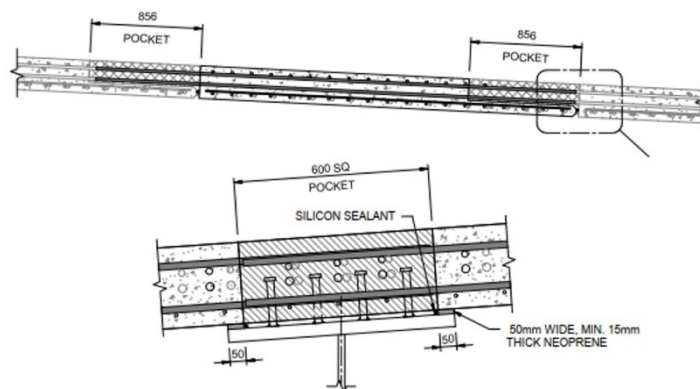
Detalle típico de juntas transversales (detalle superior) y longitudinales (detalle inferior)
